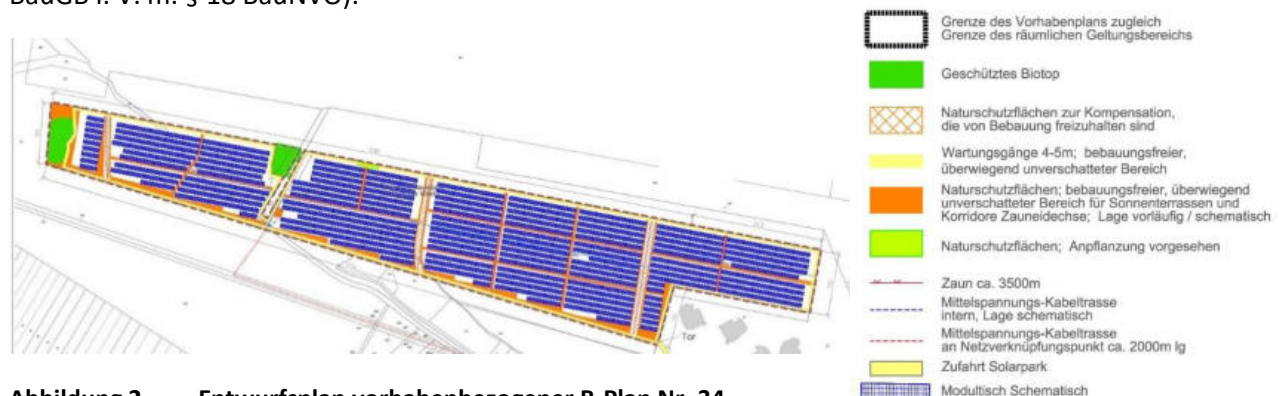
Entwurfsplan vorhabenbezogener B-Plan Nr. 34
